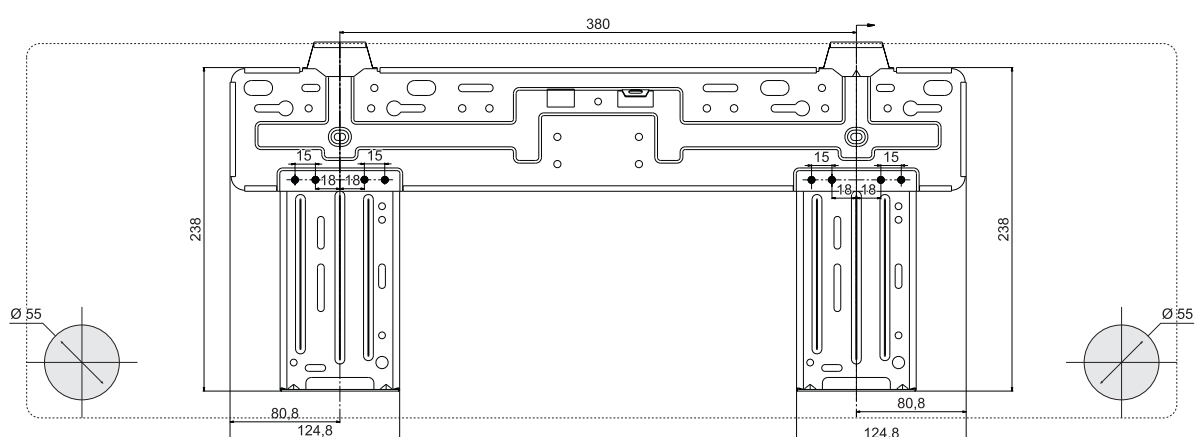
Placa de montagem para VAI 6-035 WMNI.
